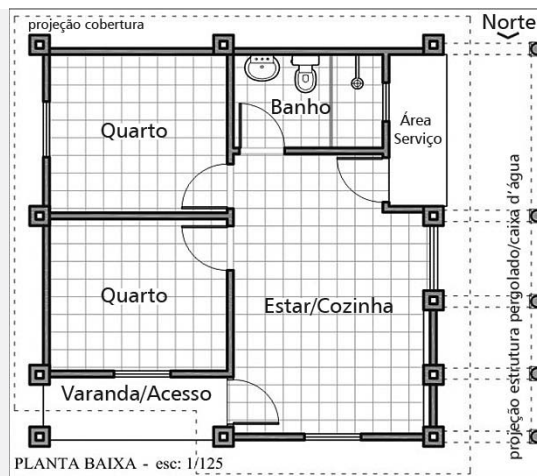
Vista norte e planta baixa do protótipo Casa Alvorada
